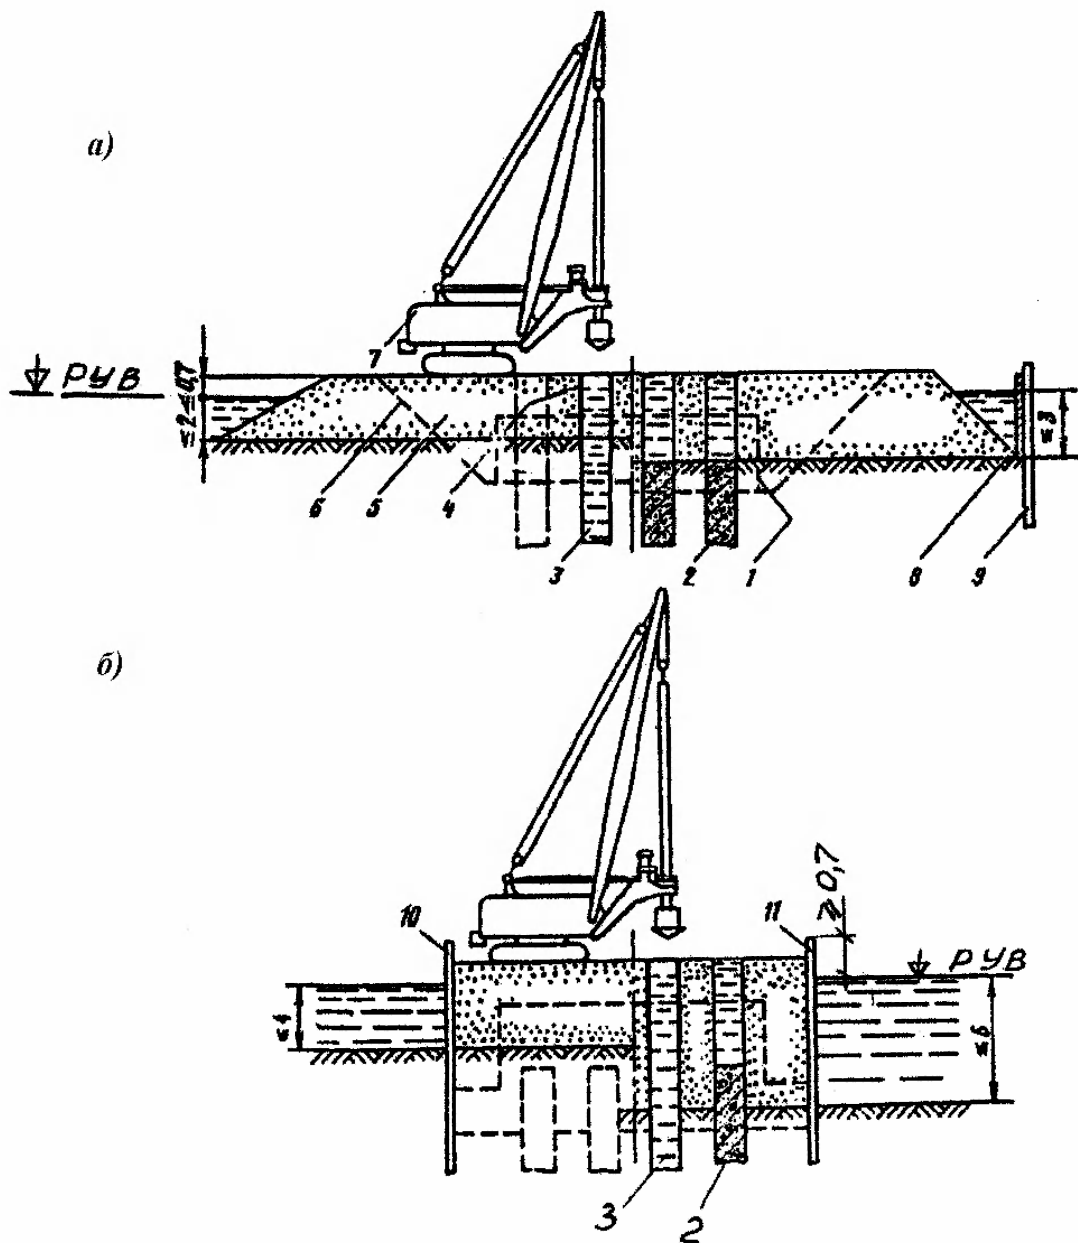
Искусственные островки для сооружения фундаментов для из буровых свай:
